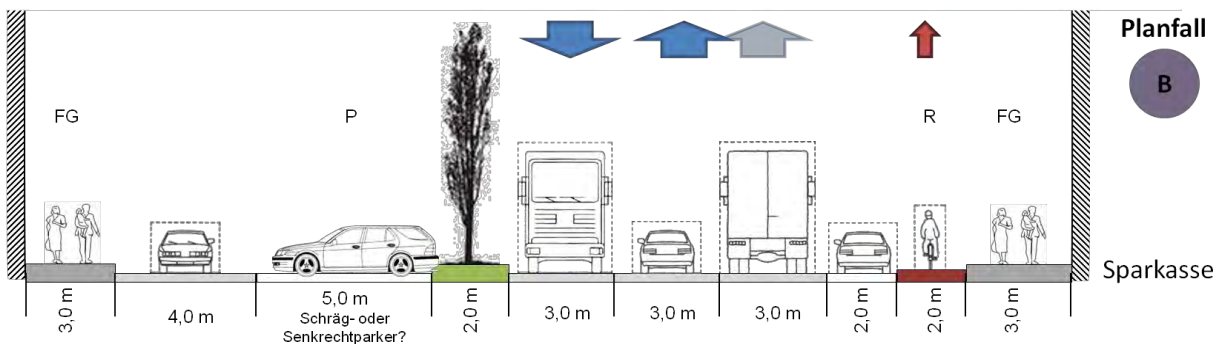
Werinherstraße mit Ertüchtigung für Zweirichtungsverkehr (Planfall B)
